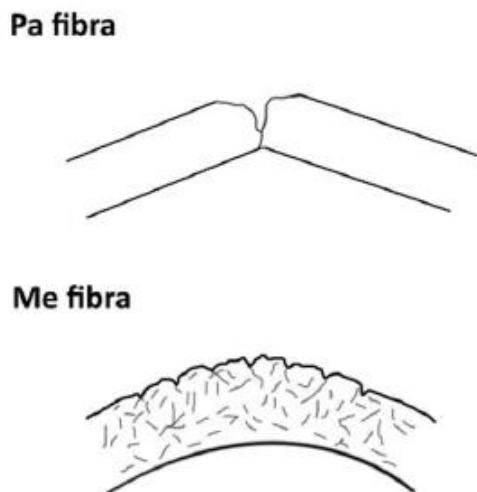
Thyerja e elementit të betonit pa praninë e fibrave dhe në prani të fibrave
